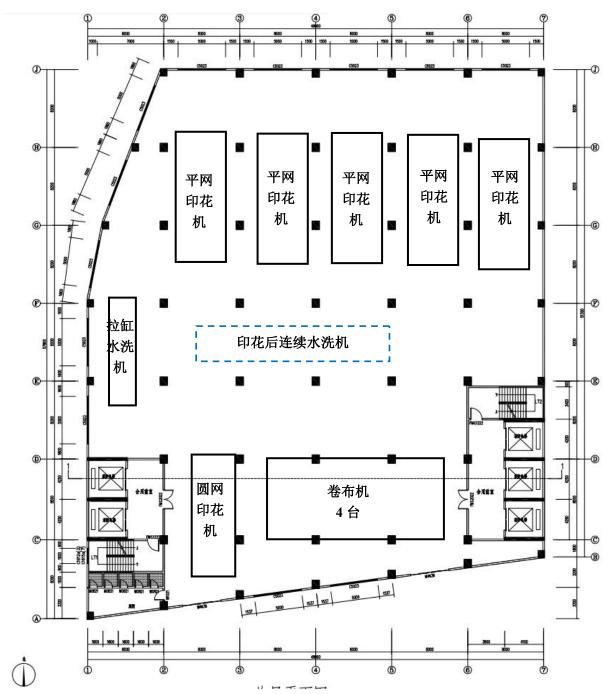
原有项目 (B 栋厂房) 5 楼平面布置图
